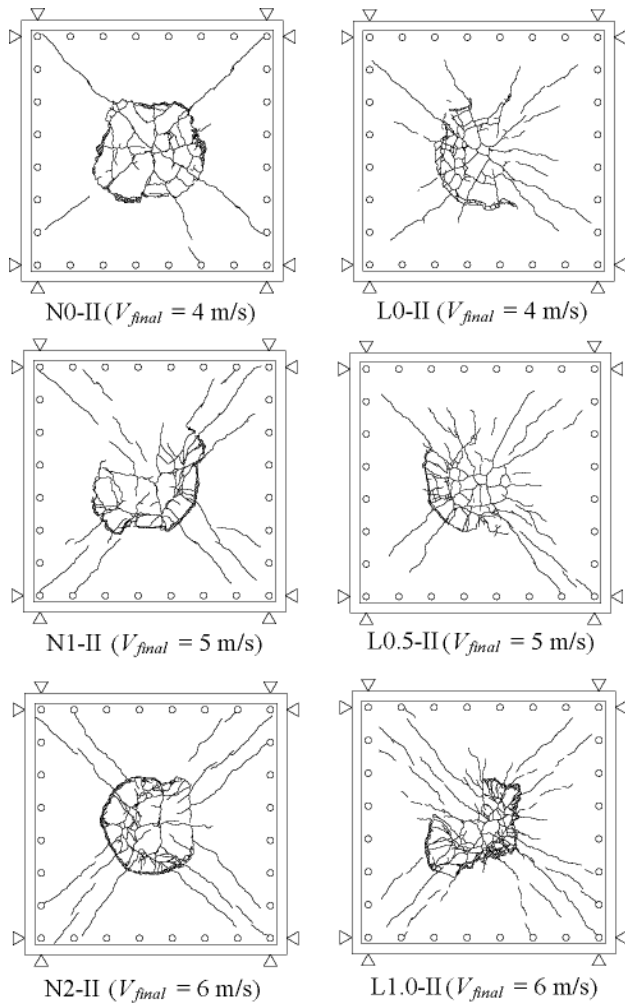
衝撃実験後の各試験体下面のひび割れ状況
